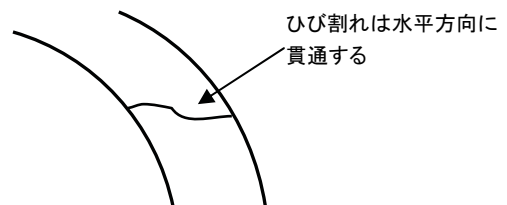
コールドジョイントによるひび割れの発生方向 (断面内)
